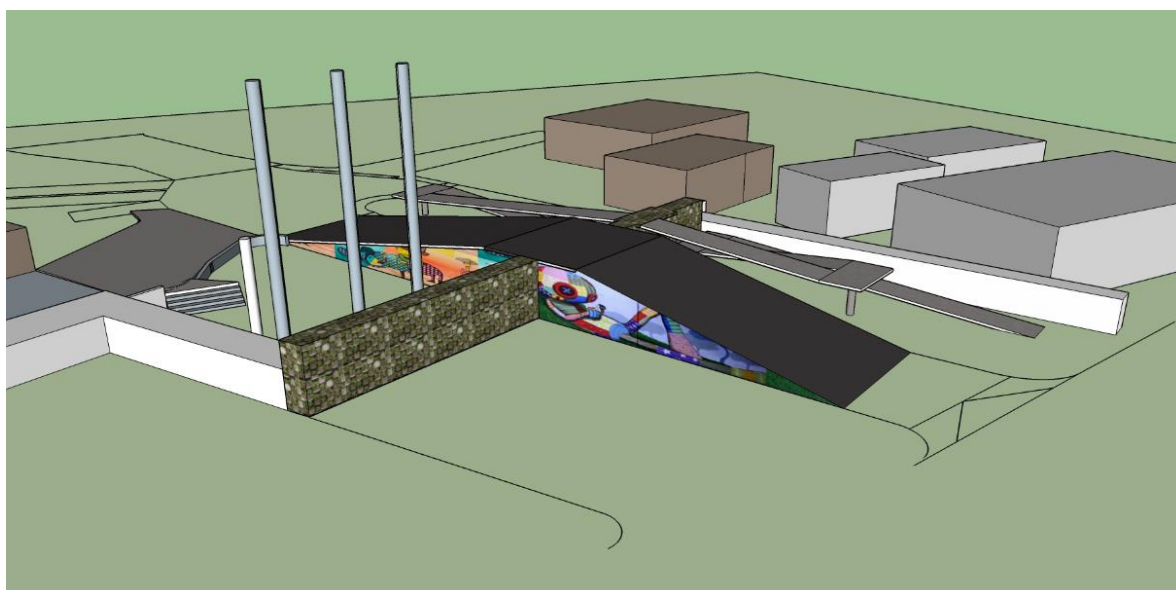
Maquete da solução de engenharia proposta para o recorte no muro de pedra na rua de acesso ao Restaurante Pesqueirinho.
